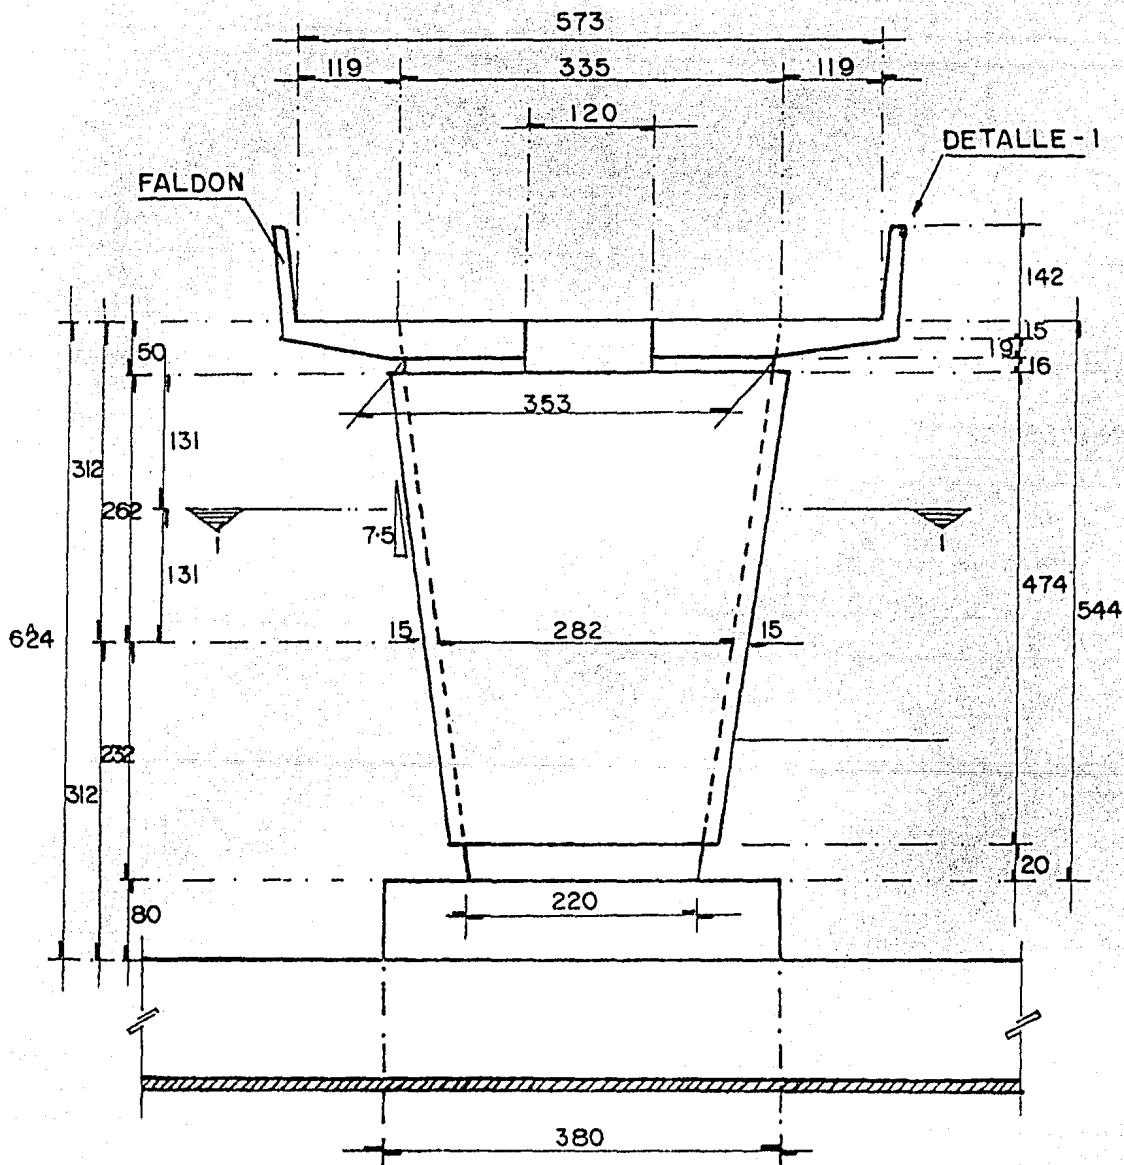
VISTA FRONTAL DE LA COLUMNA
